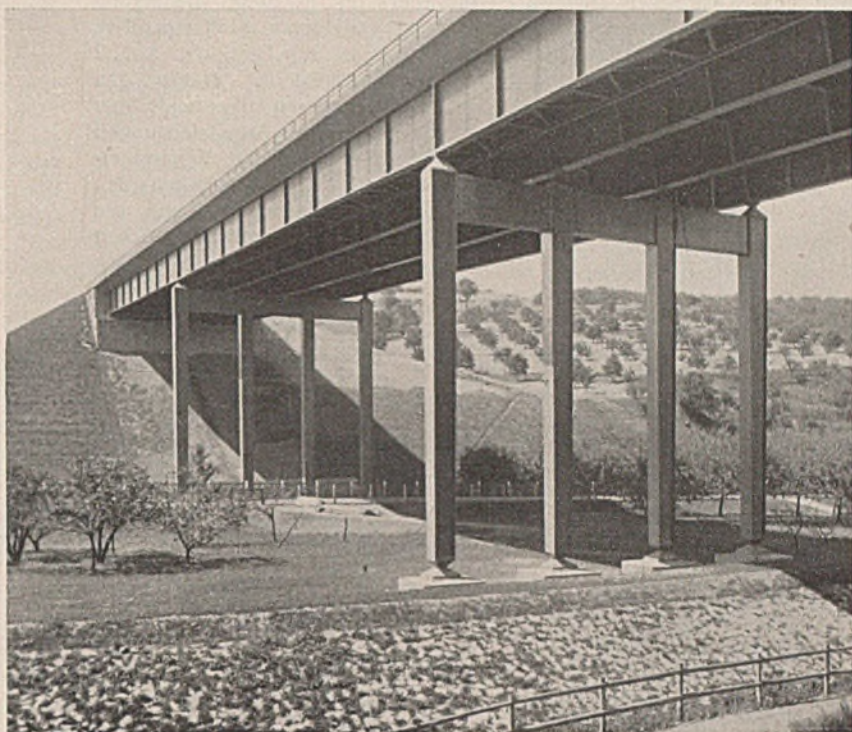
Rechteckige Hohlquerschnitte für Stützen.
